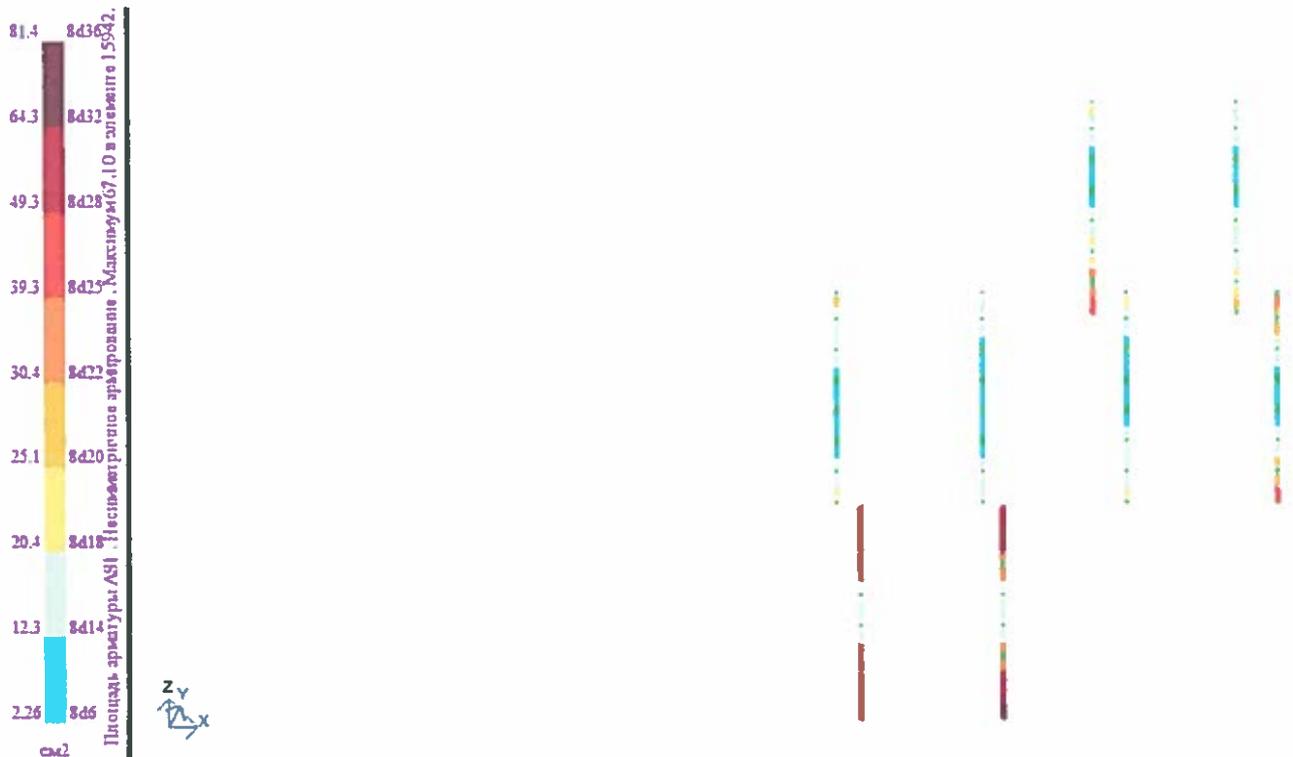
необхідна площа арматури AS1 (колони круглого перерізу з відмітки -9,8 до -1,0)
